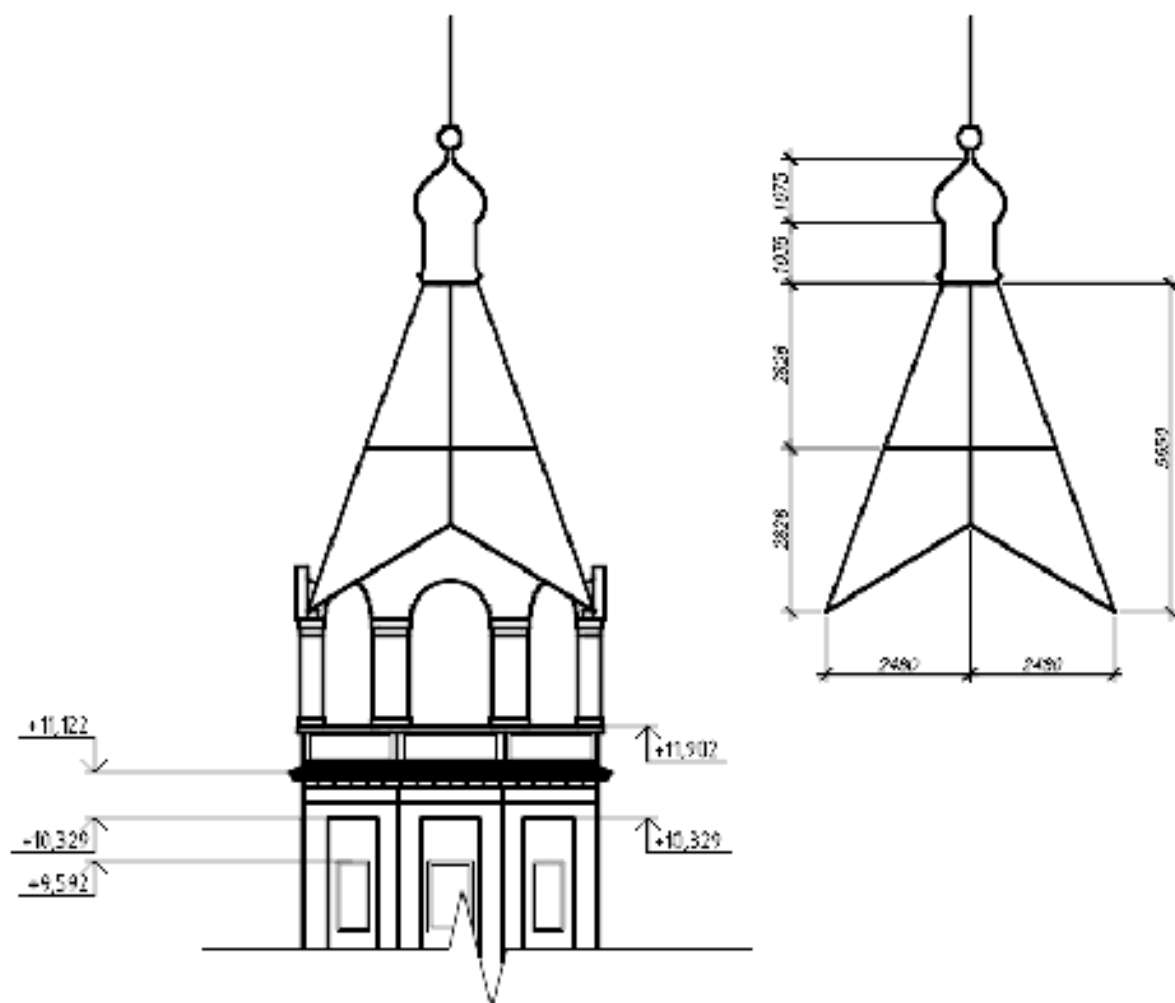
Схема конструкции колокольни. К определению ветровой нагрузки.
